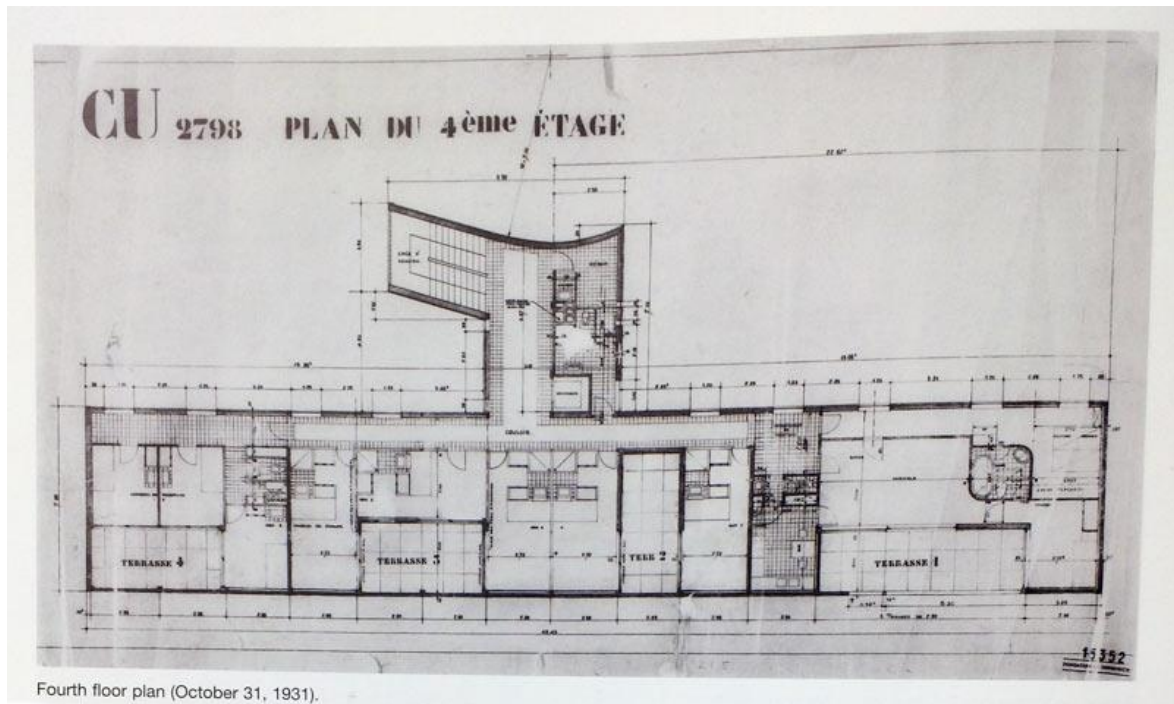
Pianta piano quarto - Fonte: www.archinect.com
